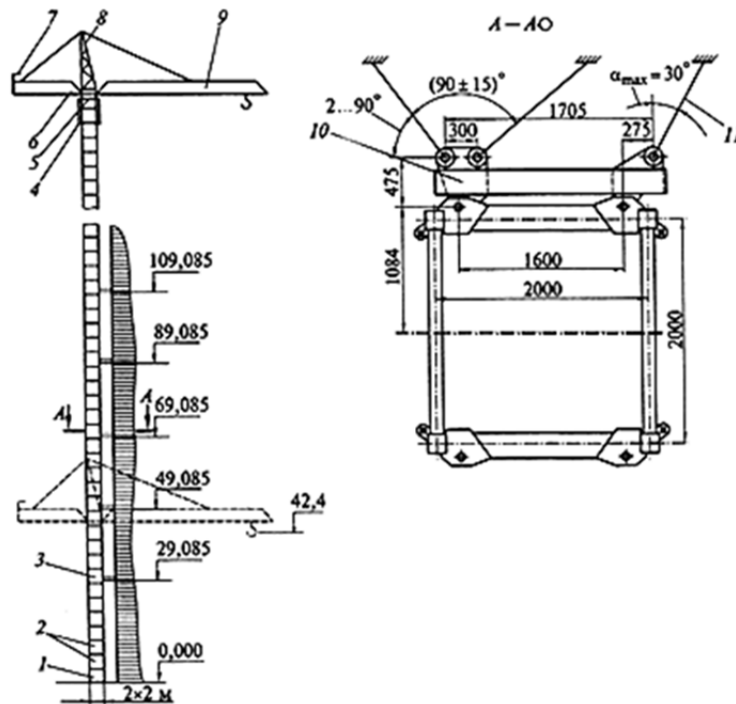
Общий вид и схема крепления к зданию крана КБ-473
